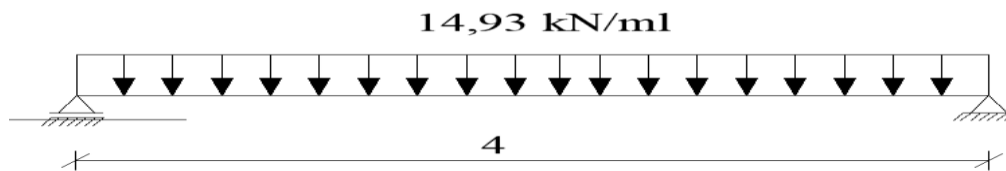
Schéma statique de la poutre de chaînage à l'E.L.U
